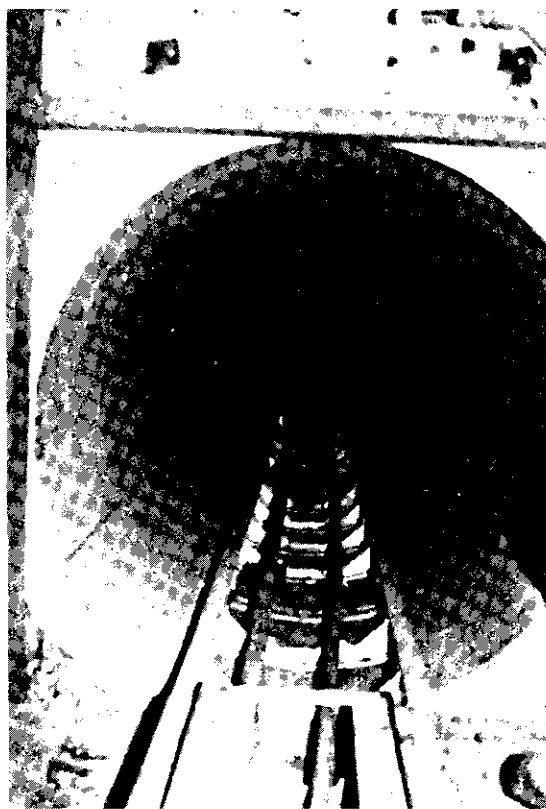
Minitúnel executado onde se observa a ausência de vazamentos.
